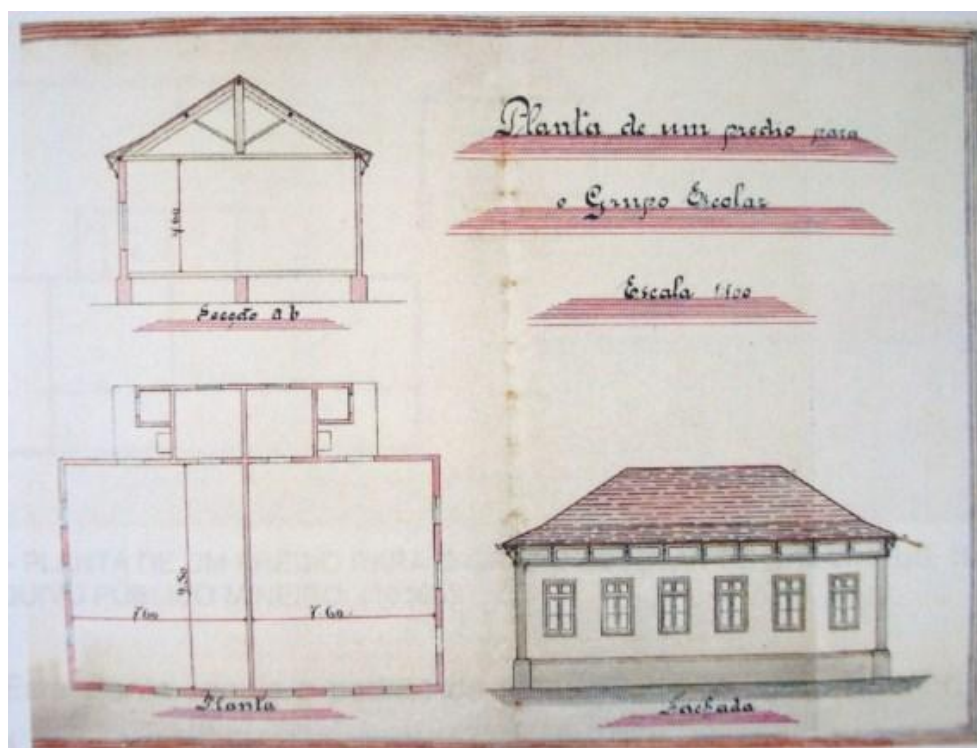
PLANTA PARA UM GRUPO ESCOLAR, 1916.
